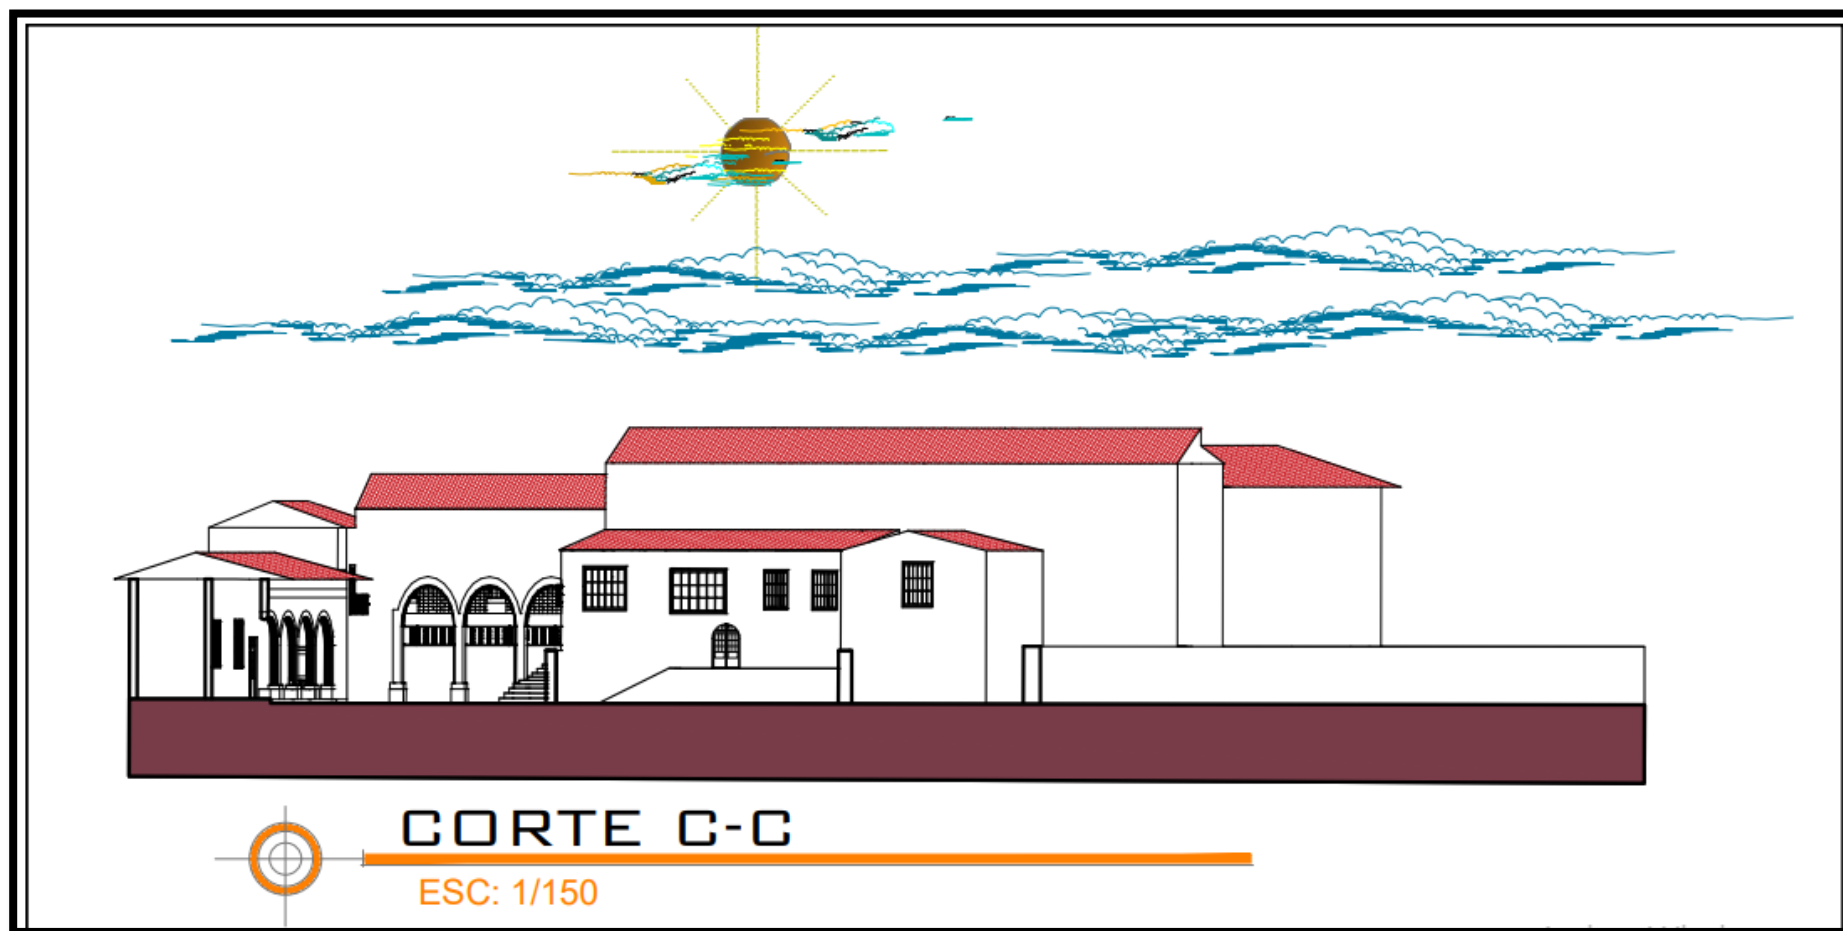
Plano de corte general de la hacienda Vichaycoto sección C-C.
